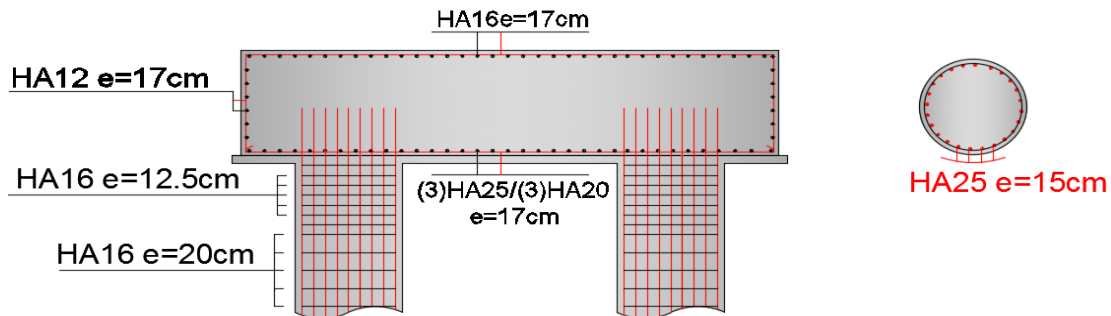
Ferrailage des pieux et semelle des culés
